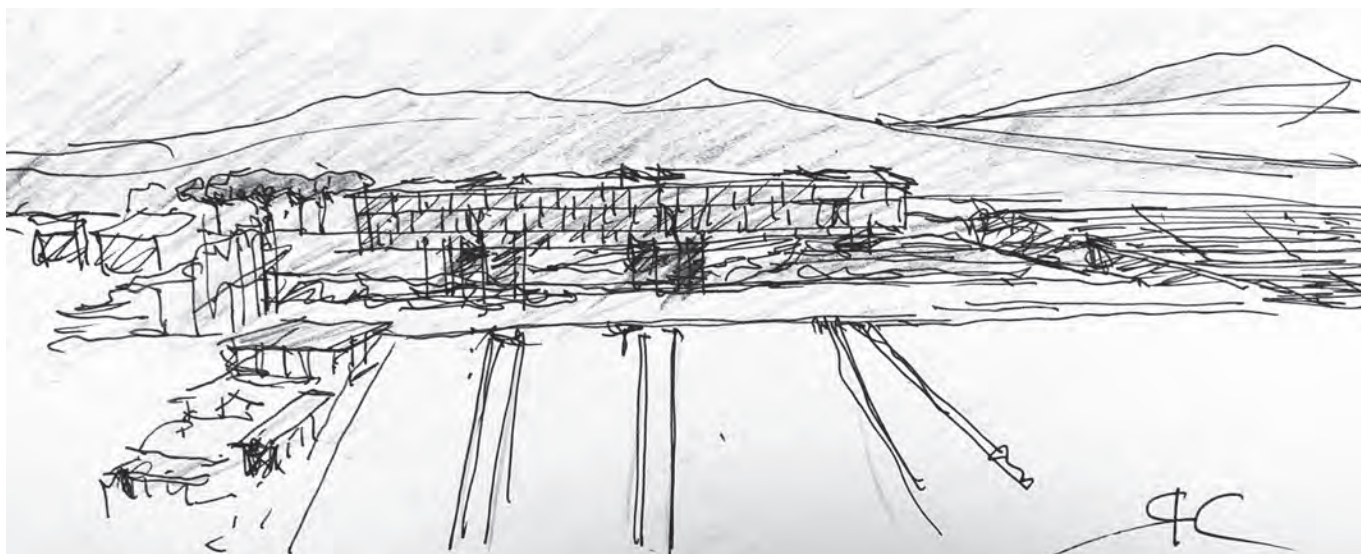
Schizzo prospettico da nord, studio planivolumetrico e profilo (disegni dell'autore)
